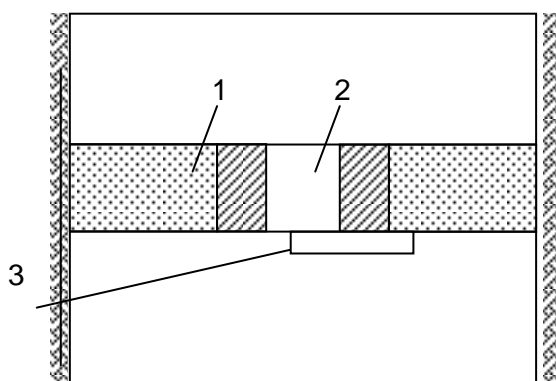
Схема устройства вентиляционного окна в выработке
